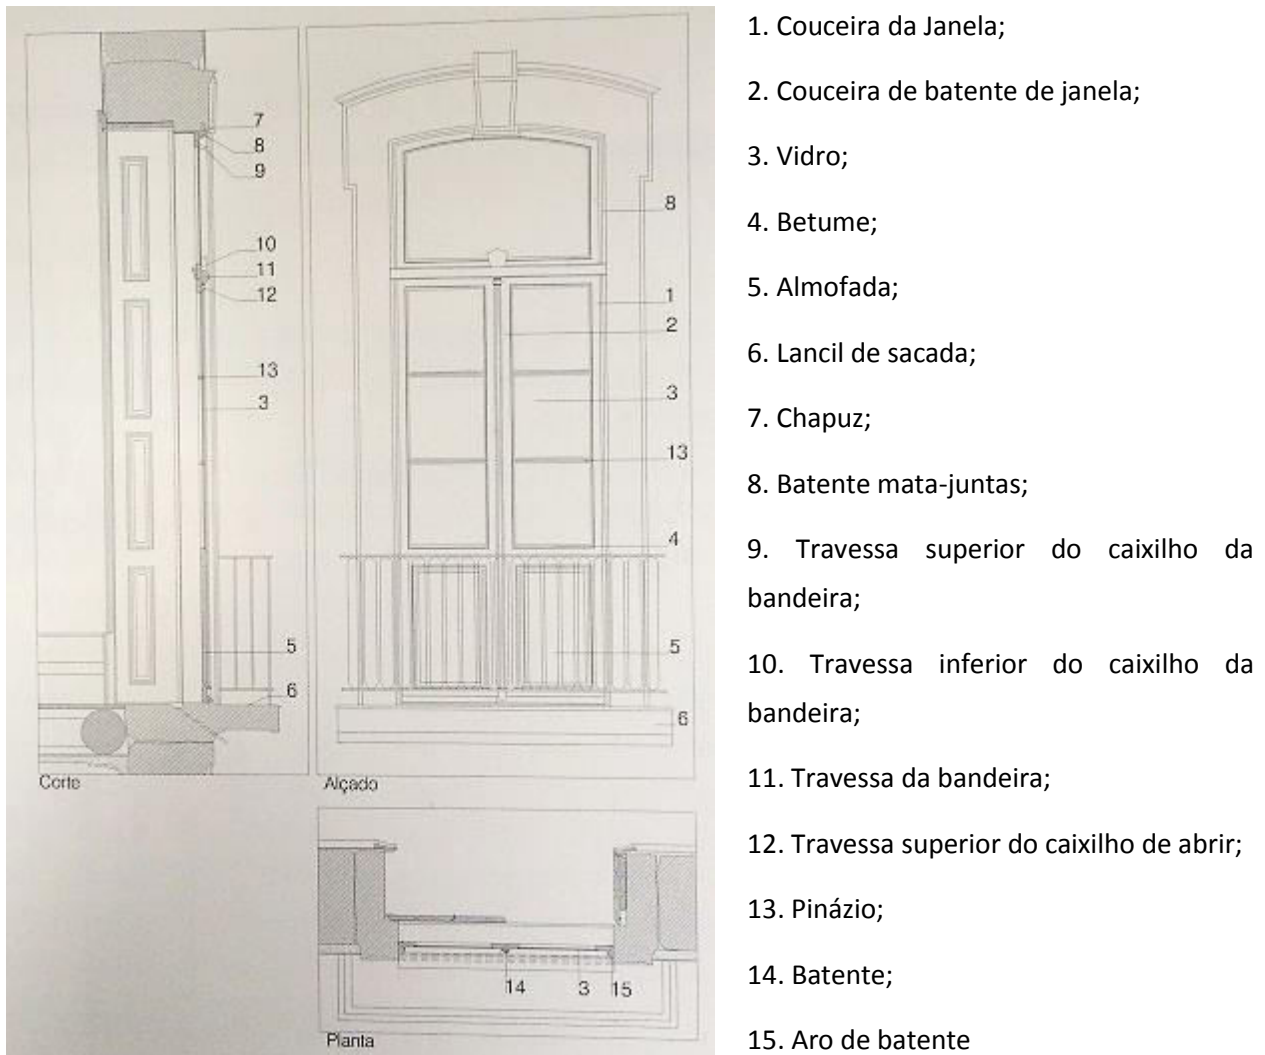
Planta, corte e alçado tipo de janela de sacada de batente [4].
